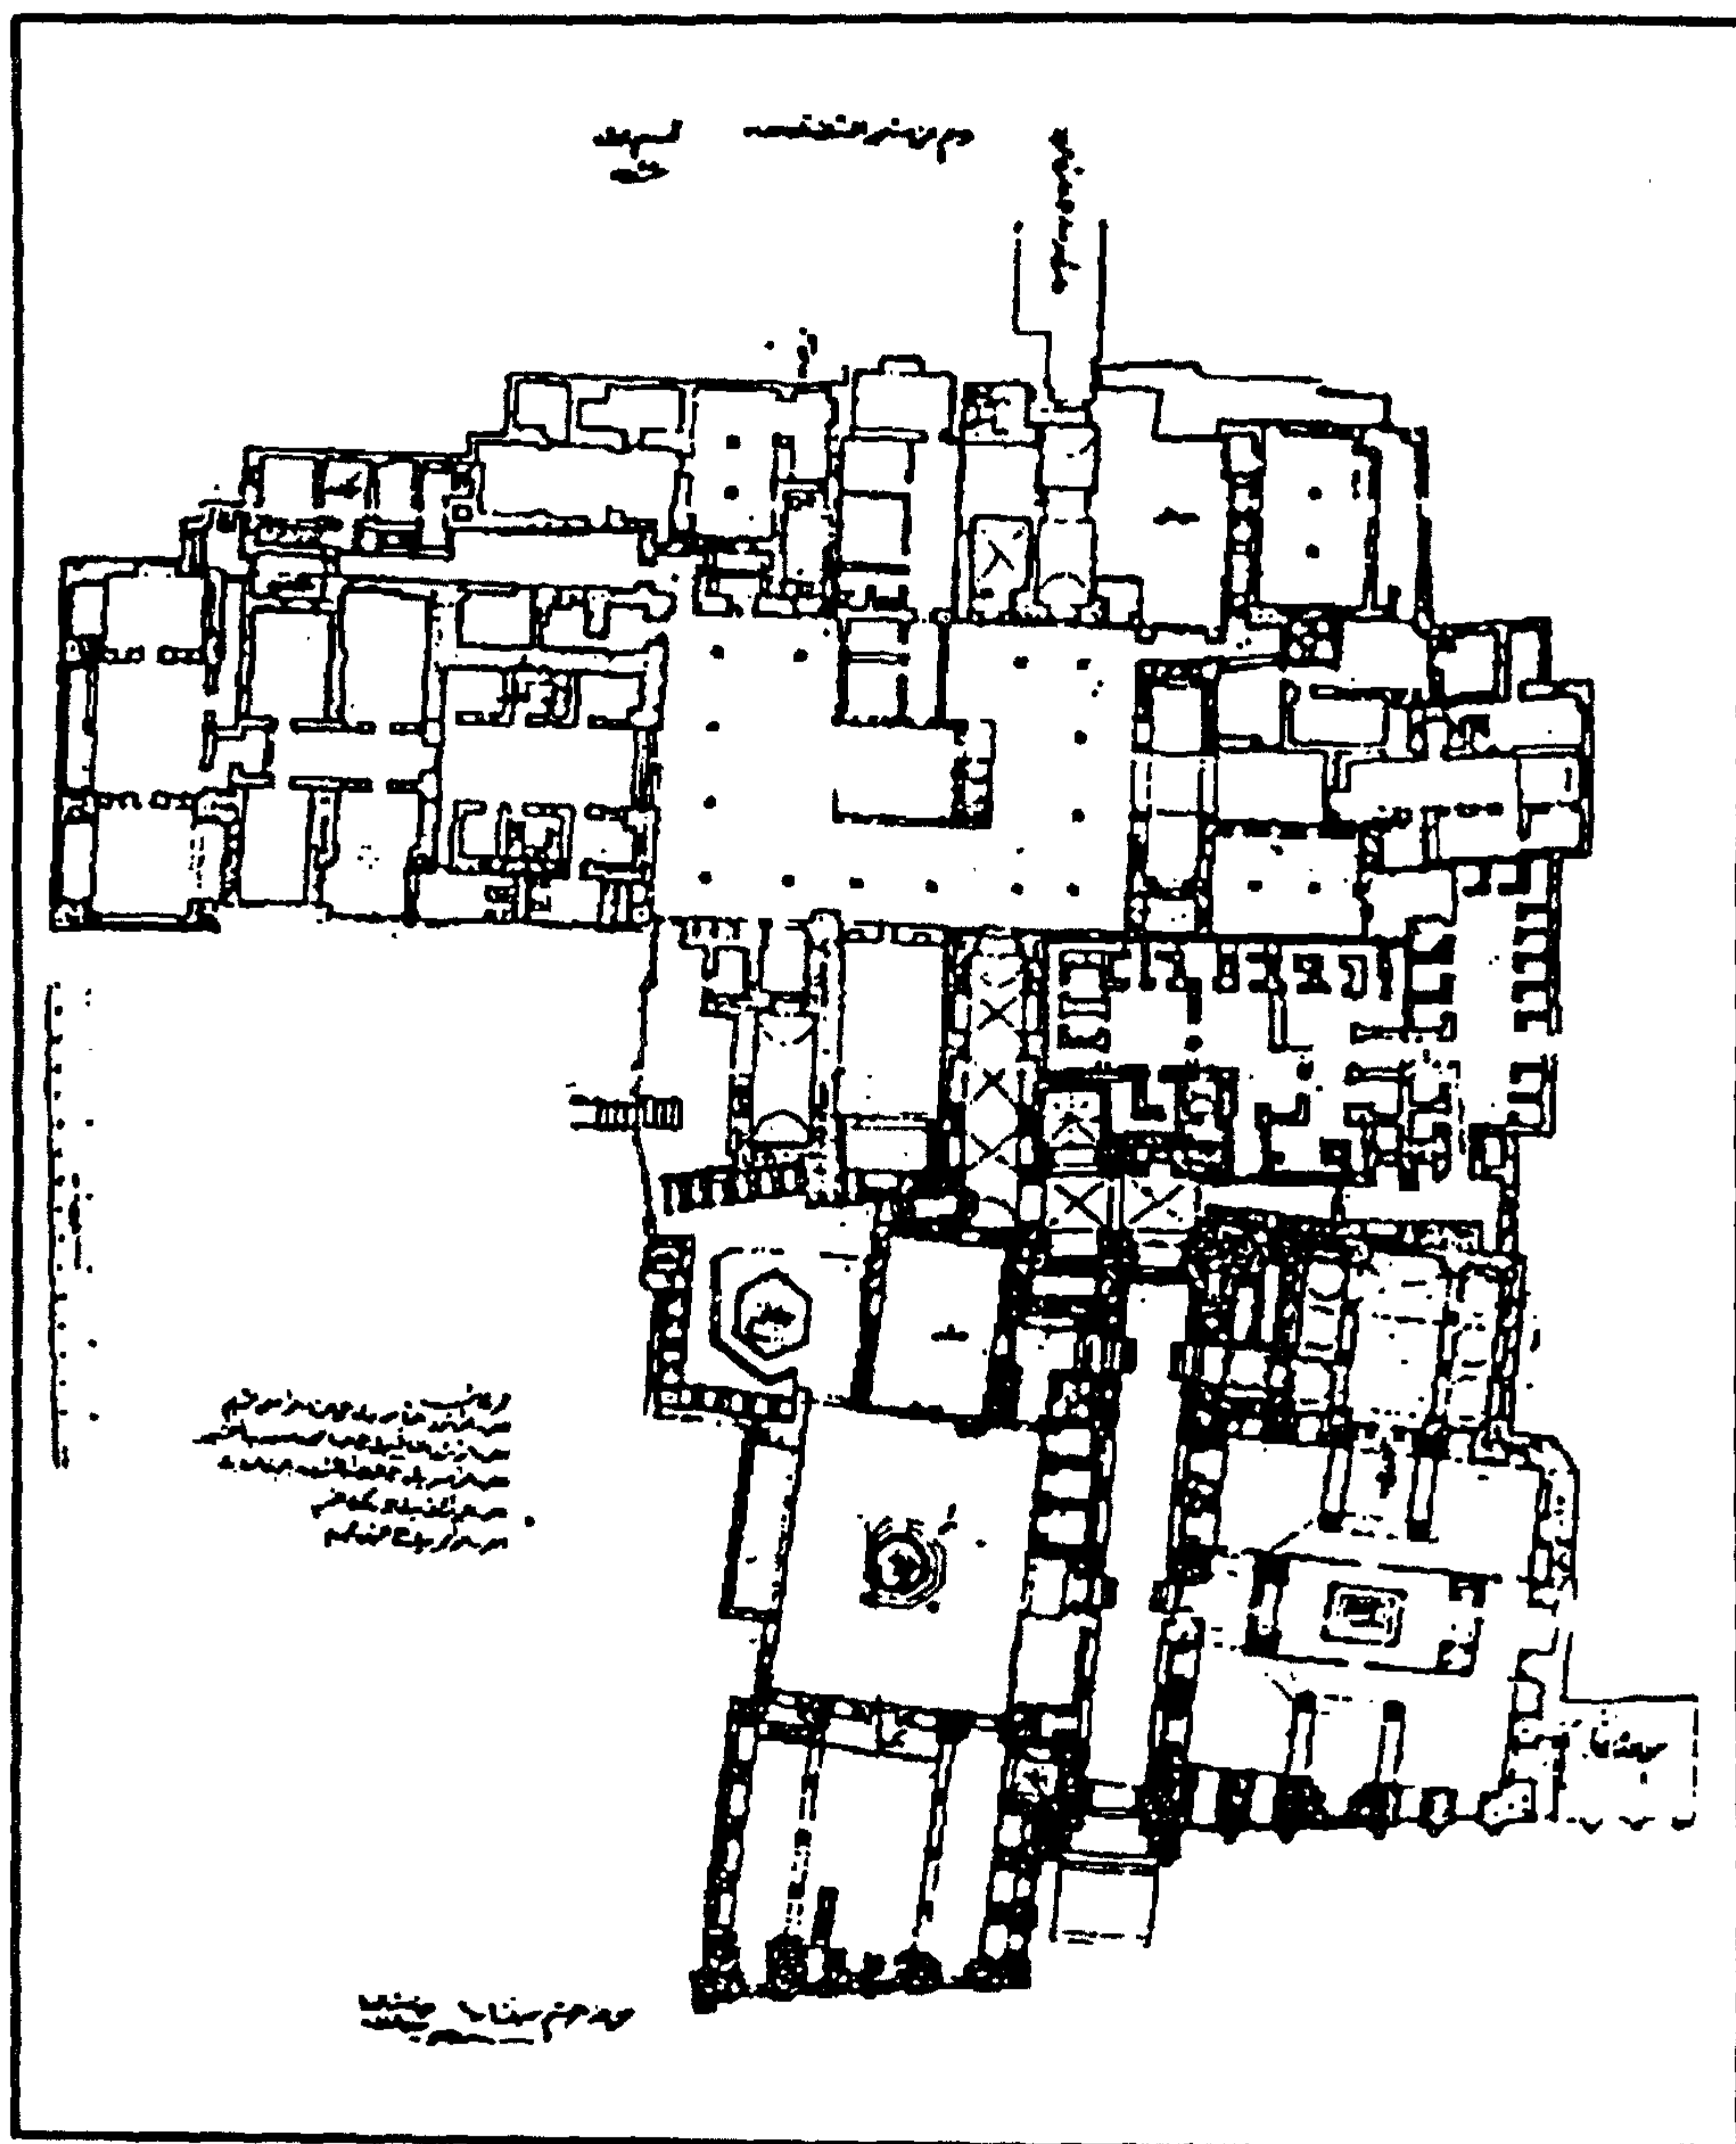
مسقط أفقى لباب التوفيق .
